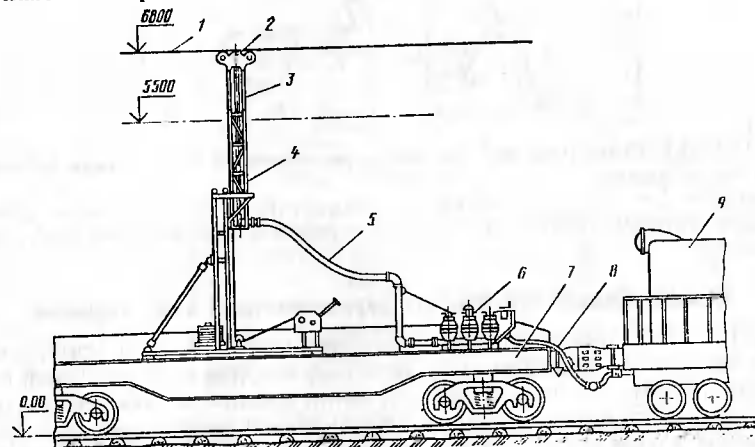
Установка для нанесения противогололедного смазочного материала на контактные провода:
